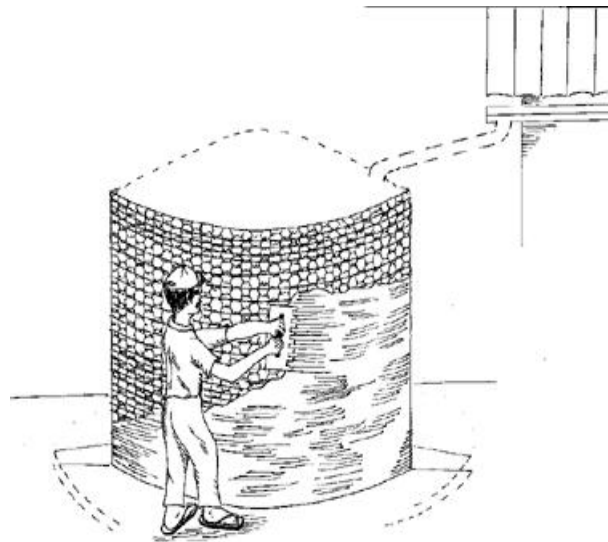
Cisterna de tela-cimento (colocação da primeira camada de argamassa acima da tela).
